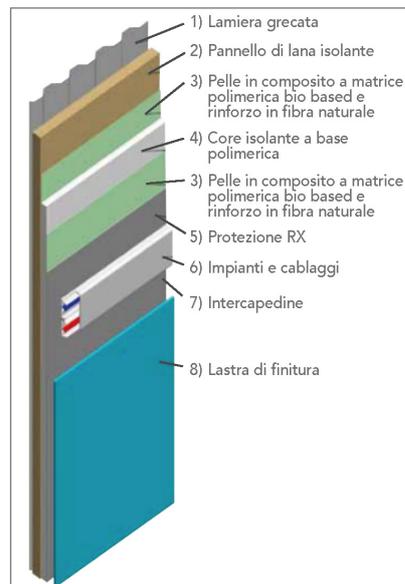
Progetto della pannellatura esterna dello shelter. La parete del perimetro esterno dello shelter è stata progettata da R.I. SpA, capofila del progetto
